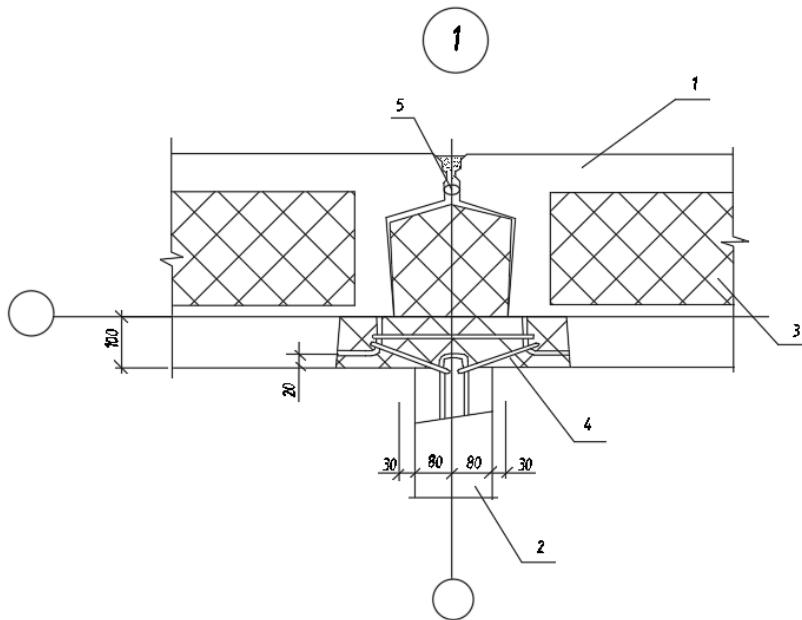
Стык внешних стеновых панелей с внутренними: 1 – наружная стеновая панель ЗНС; 2 – внутренняя стеновая панель ПСВ; 3 – утеплитель; 4 – металлические скобы; 5 – вилатерм
